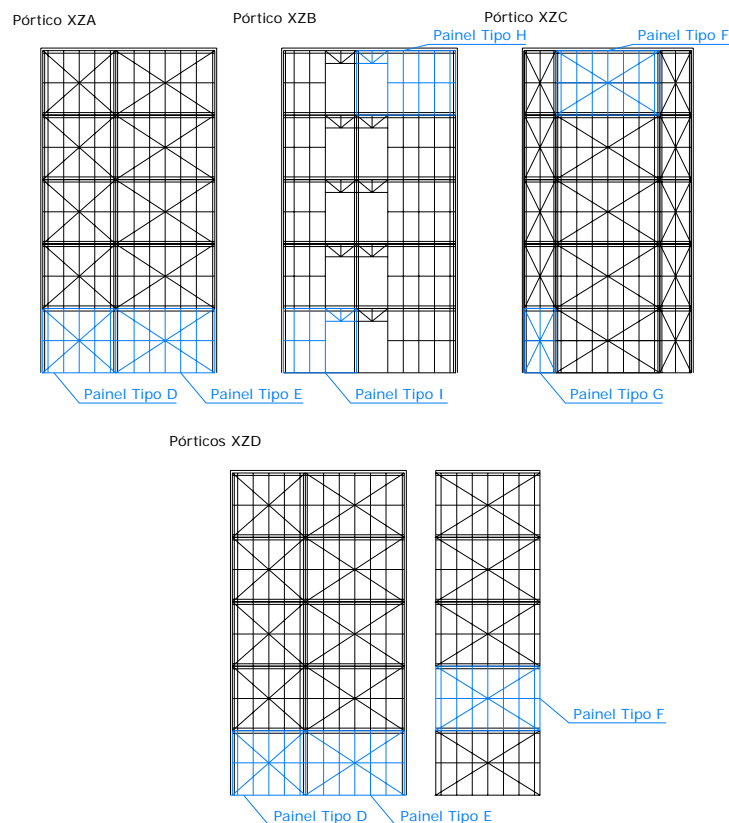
Pórticos do sistema estrutural proposto segundo a direcção x, nomeação dos painéis “steel-frame”
